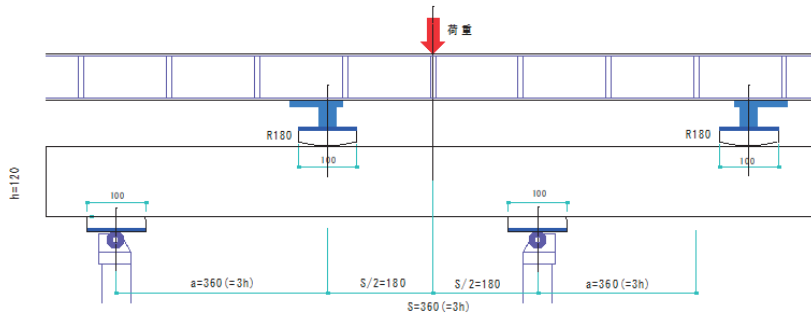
厚さ 120mm 試験体の逆対象 4 点荷重方式せん断試験の概要 (S=a=360mm)
